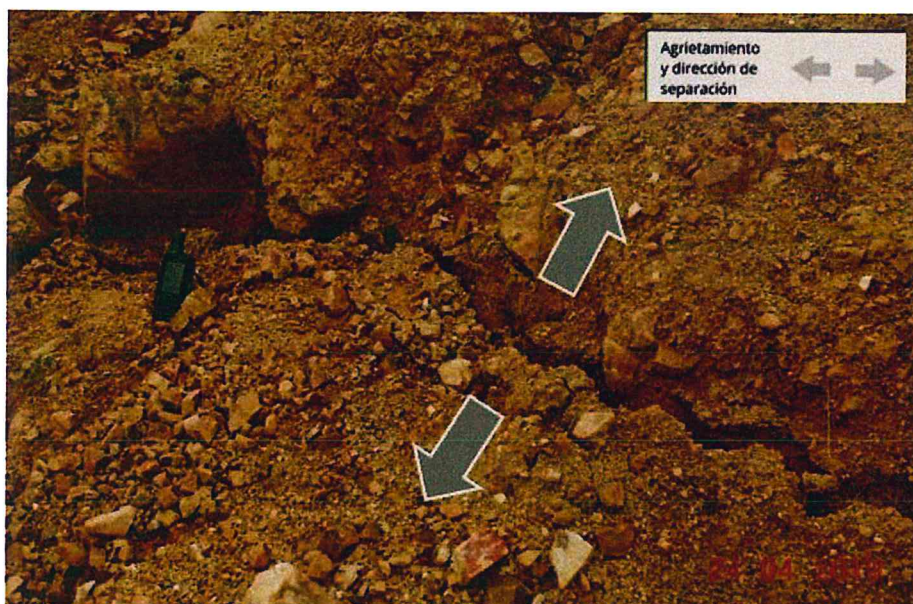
Grietas en el terreno ubicado detrás del escarpe principal.
